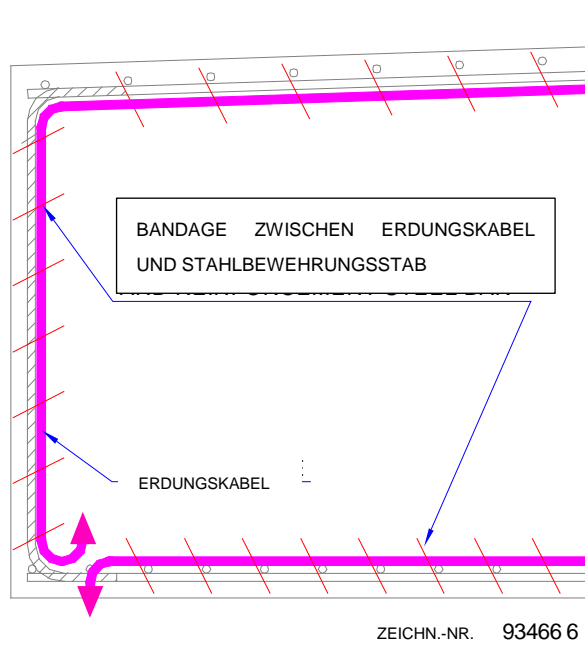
Seitenansicht auf Fundament mit installiertem Erdungskabel (Detail 2)
